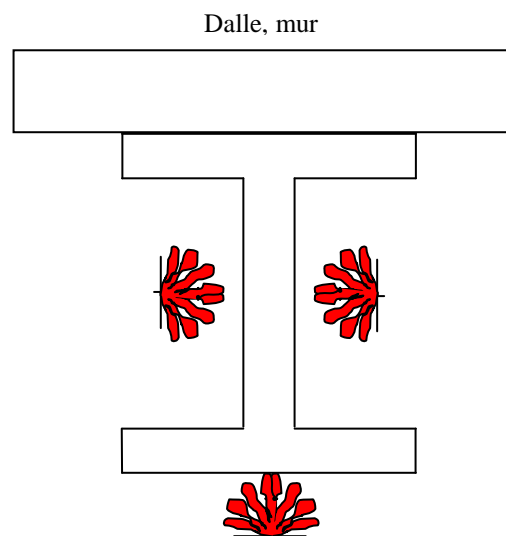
Exposition au feu des éléments (poutres, poteaux)
